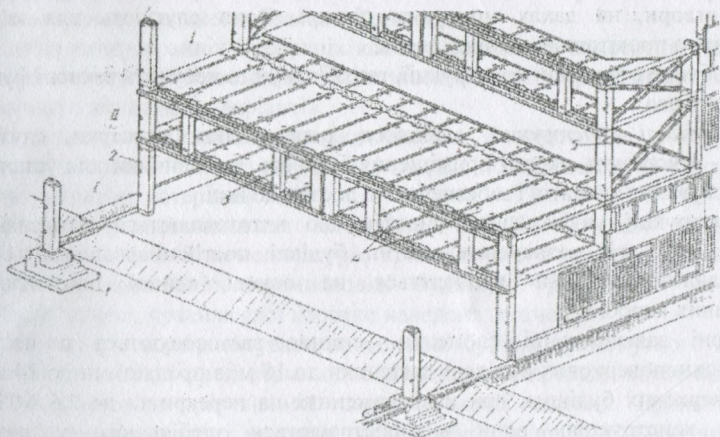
Каркас з перекриттями над виробничими поверхами, що працюють «на проліт»:
